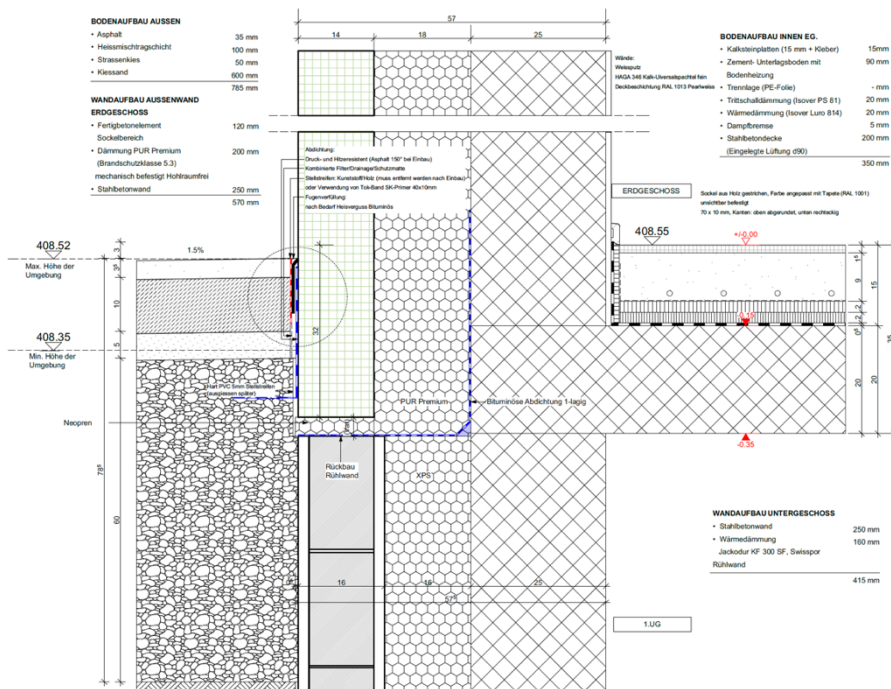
Wandaufbau Erdgeschoss-Sockeldetail
